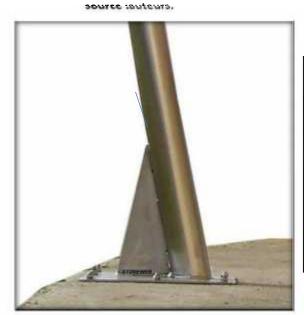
fixation du poteau inclinée source : www.voiles-tonnelles.com/mat-aciergalvanise-inox-gm
